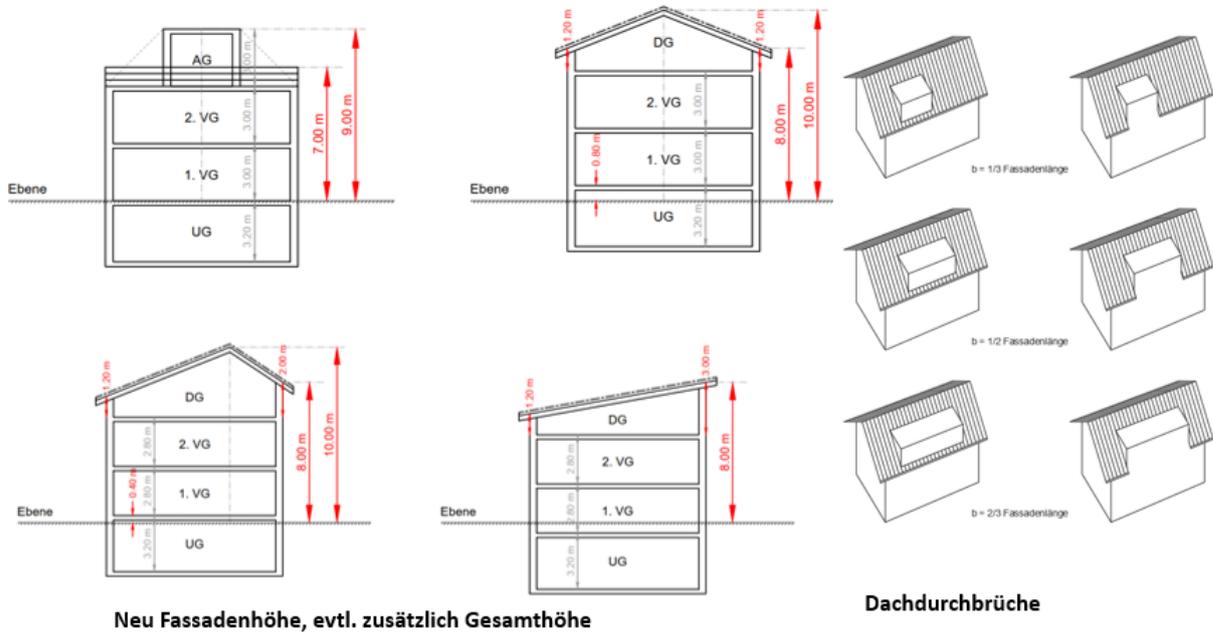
Beispiele für die Überprüfung der Baumasse (Gesamt- und Fassadenhöhe und Dachdurchbrüche)
